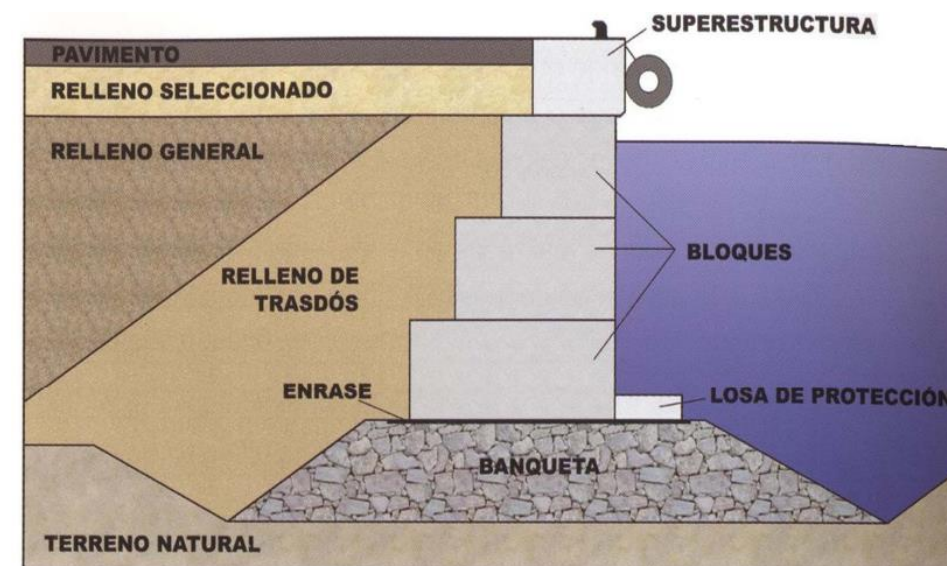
Sección de un muelle mediante Bloques de Hormigón
